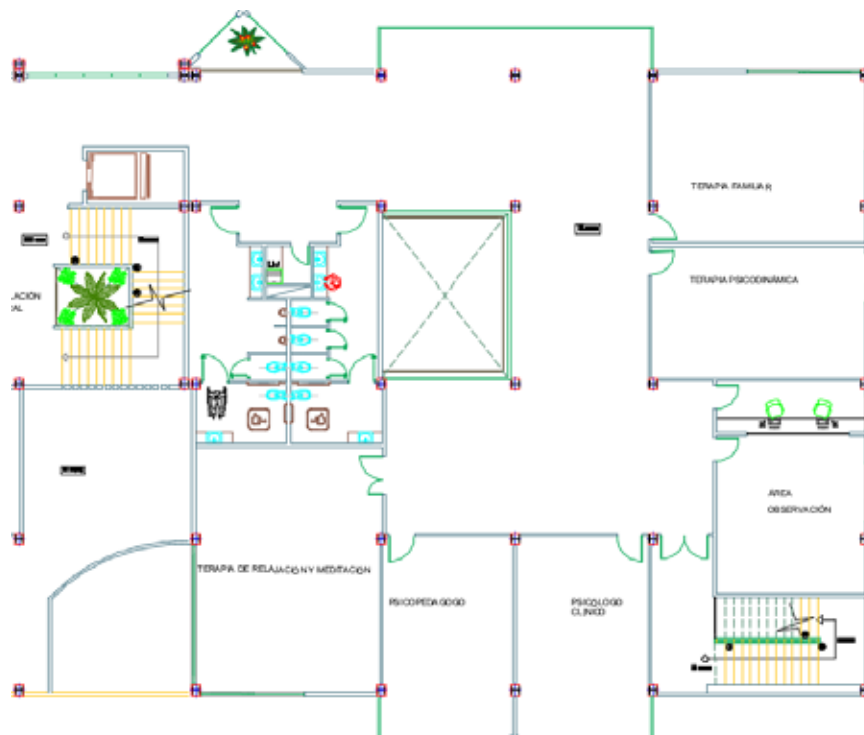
Sector B-Planta de Terapia para los Adolescentes. Nivel +4.00 y N+8.00 (2018)
